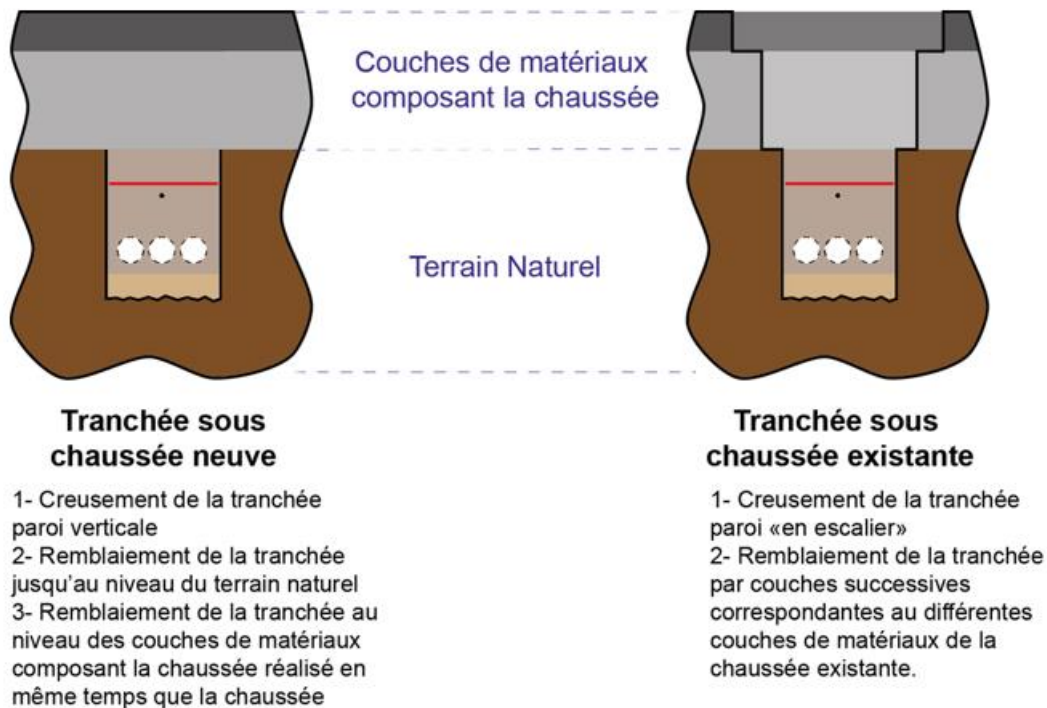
Réseau multitubulaire sous chaussées par tranchée
